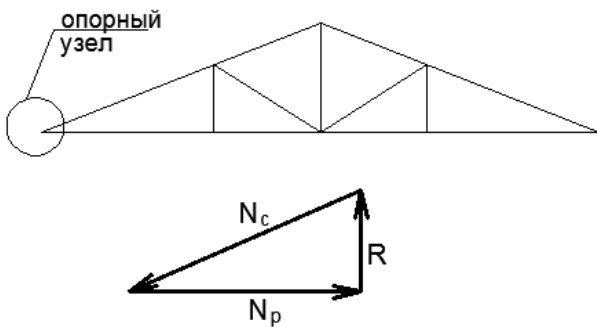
К задаче 2.1 Схема фермы и силовой треугольник
